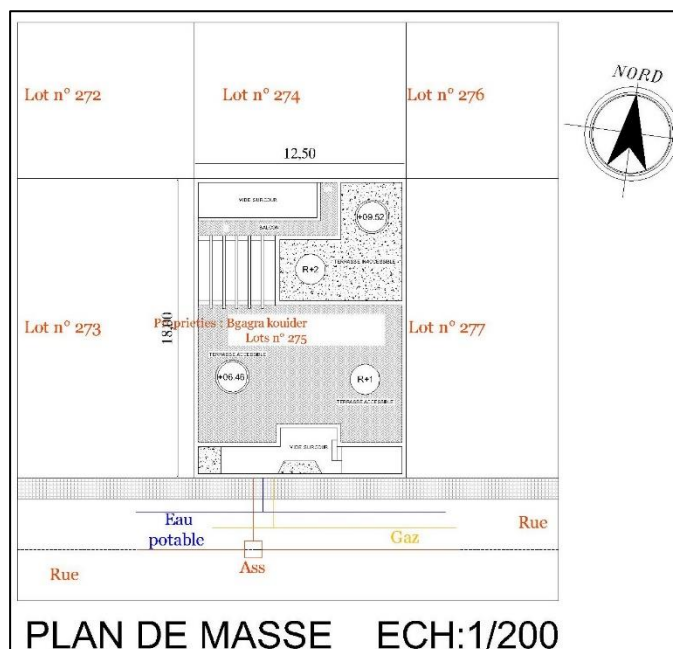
PLAN DE SITUATION ET DE MASSE
